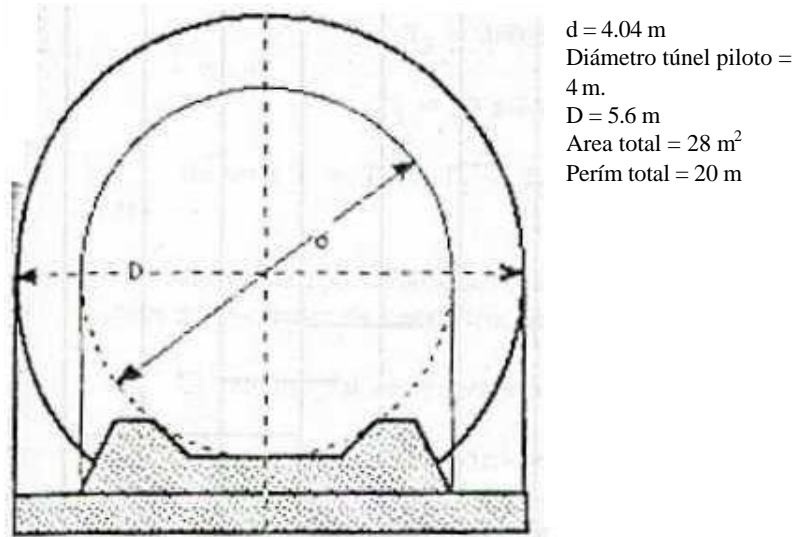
Excavación en roca para tubería de alta presión.
